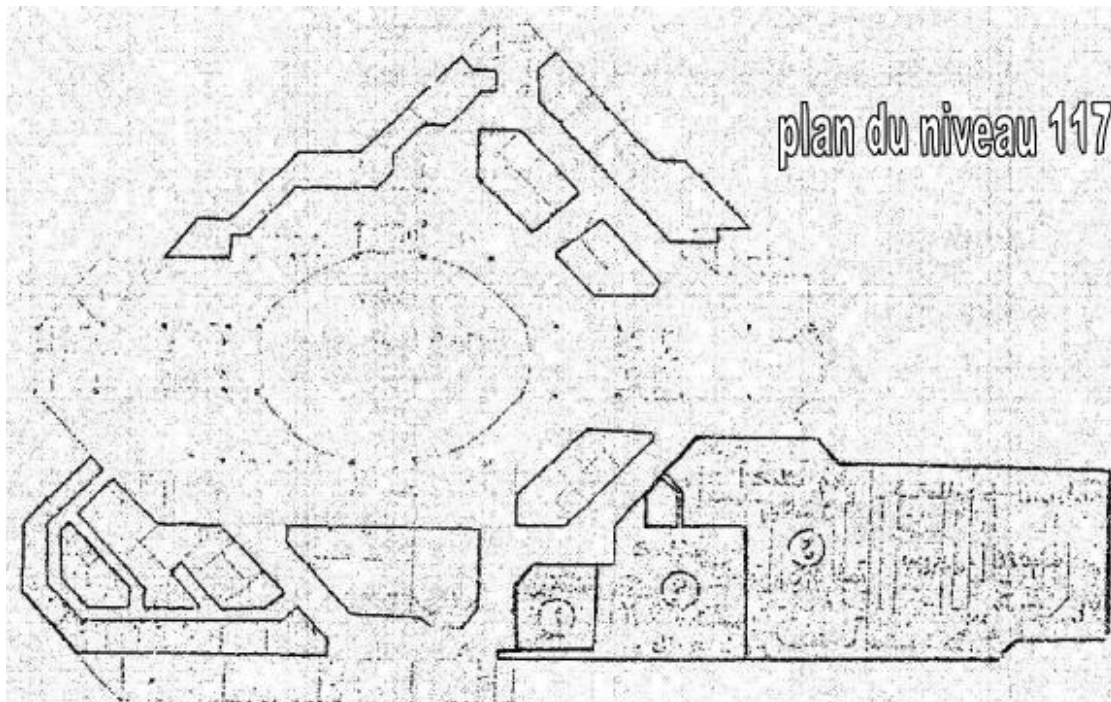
Plan de 2eme étage du centre de RIAD EL FETH.
